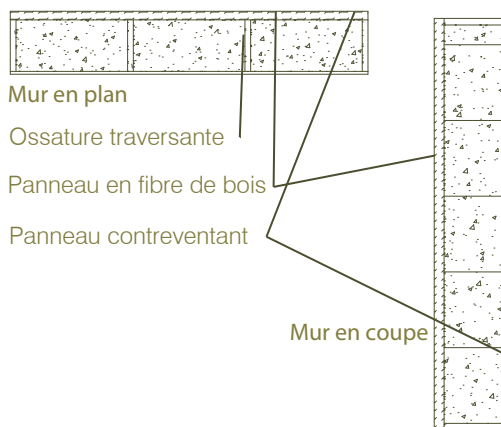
Vue en coupe et en plan du système Autrichien.
